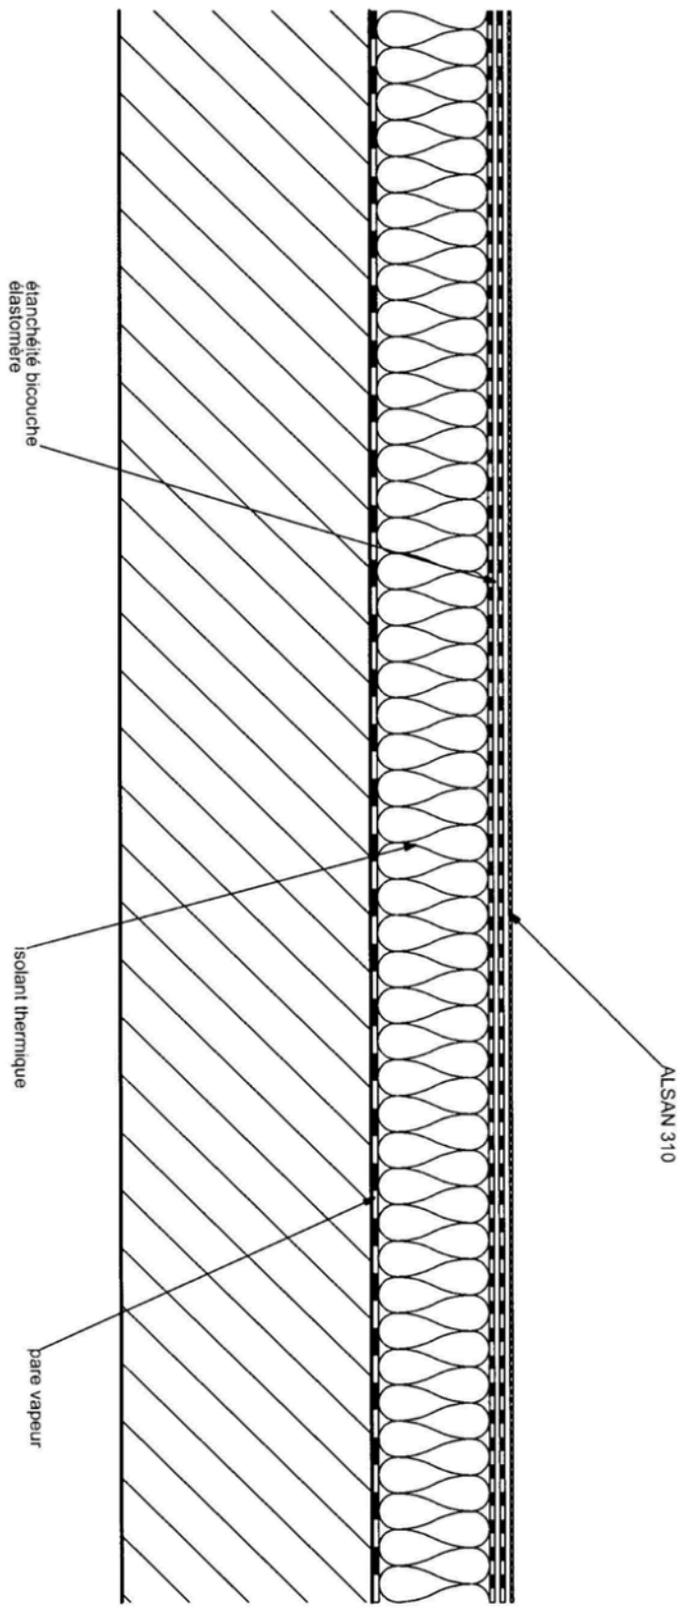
Alsan 310 sur ancienne étanchéité bitumineuse apparente
